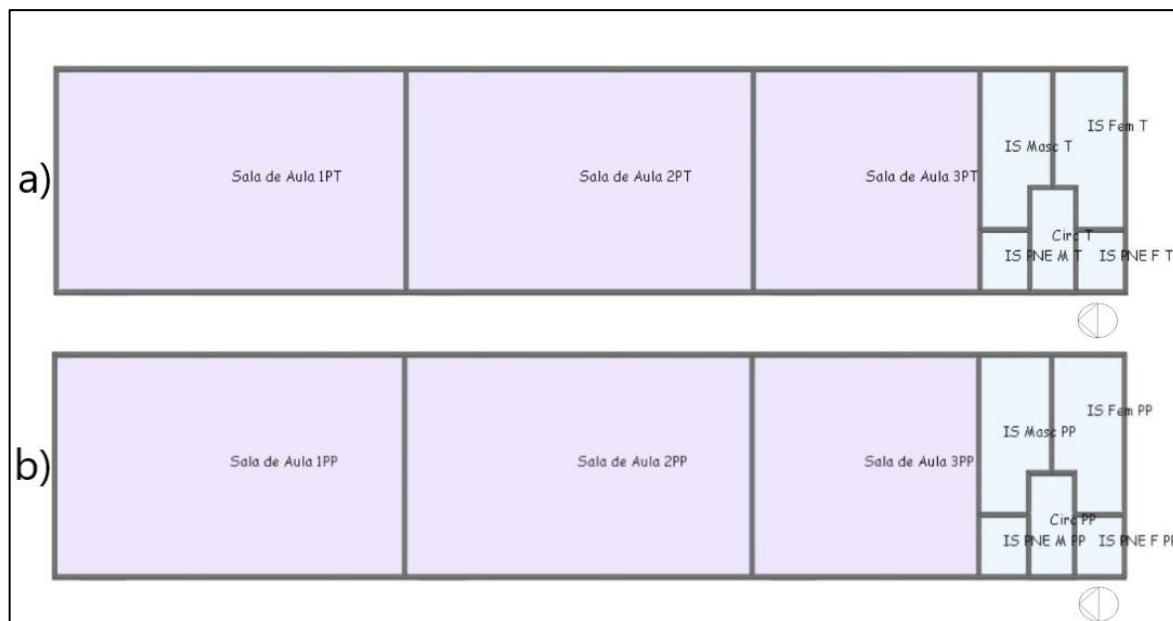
Plantas da edificação divididas em zonas, a) pavimento térreo e b) primeiro pavimento
